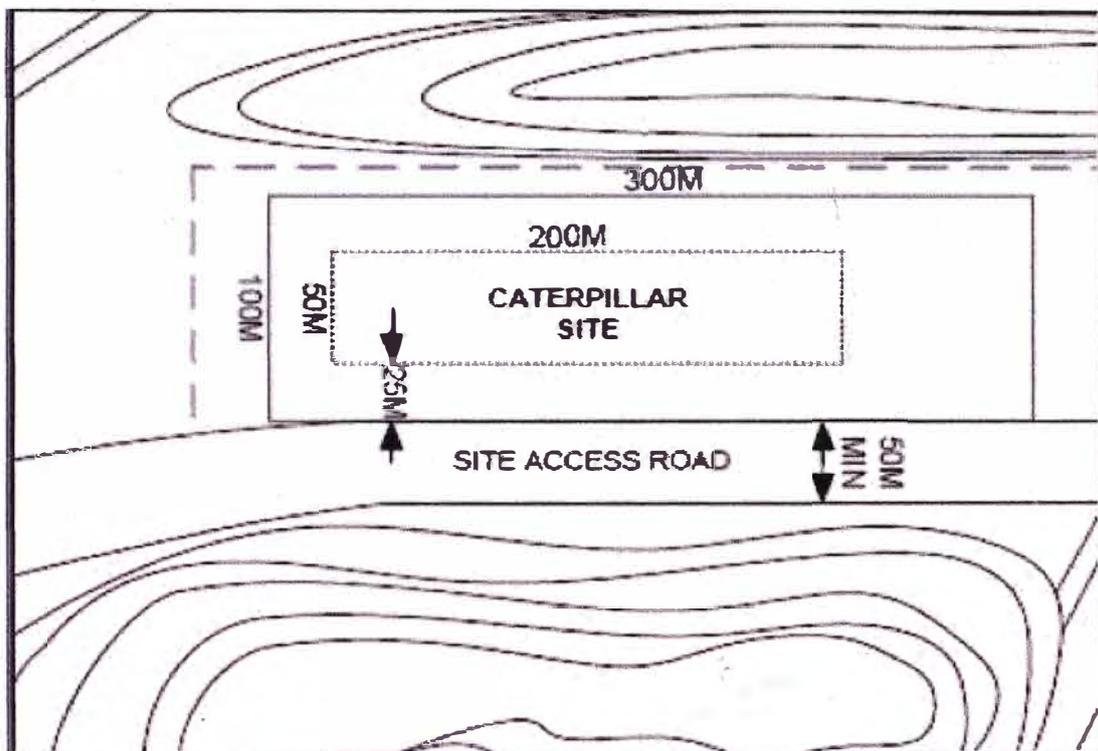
,4 Dimensiones del área de ensamblaje para el camión CAT 797F.
